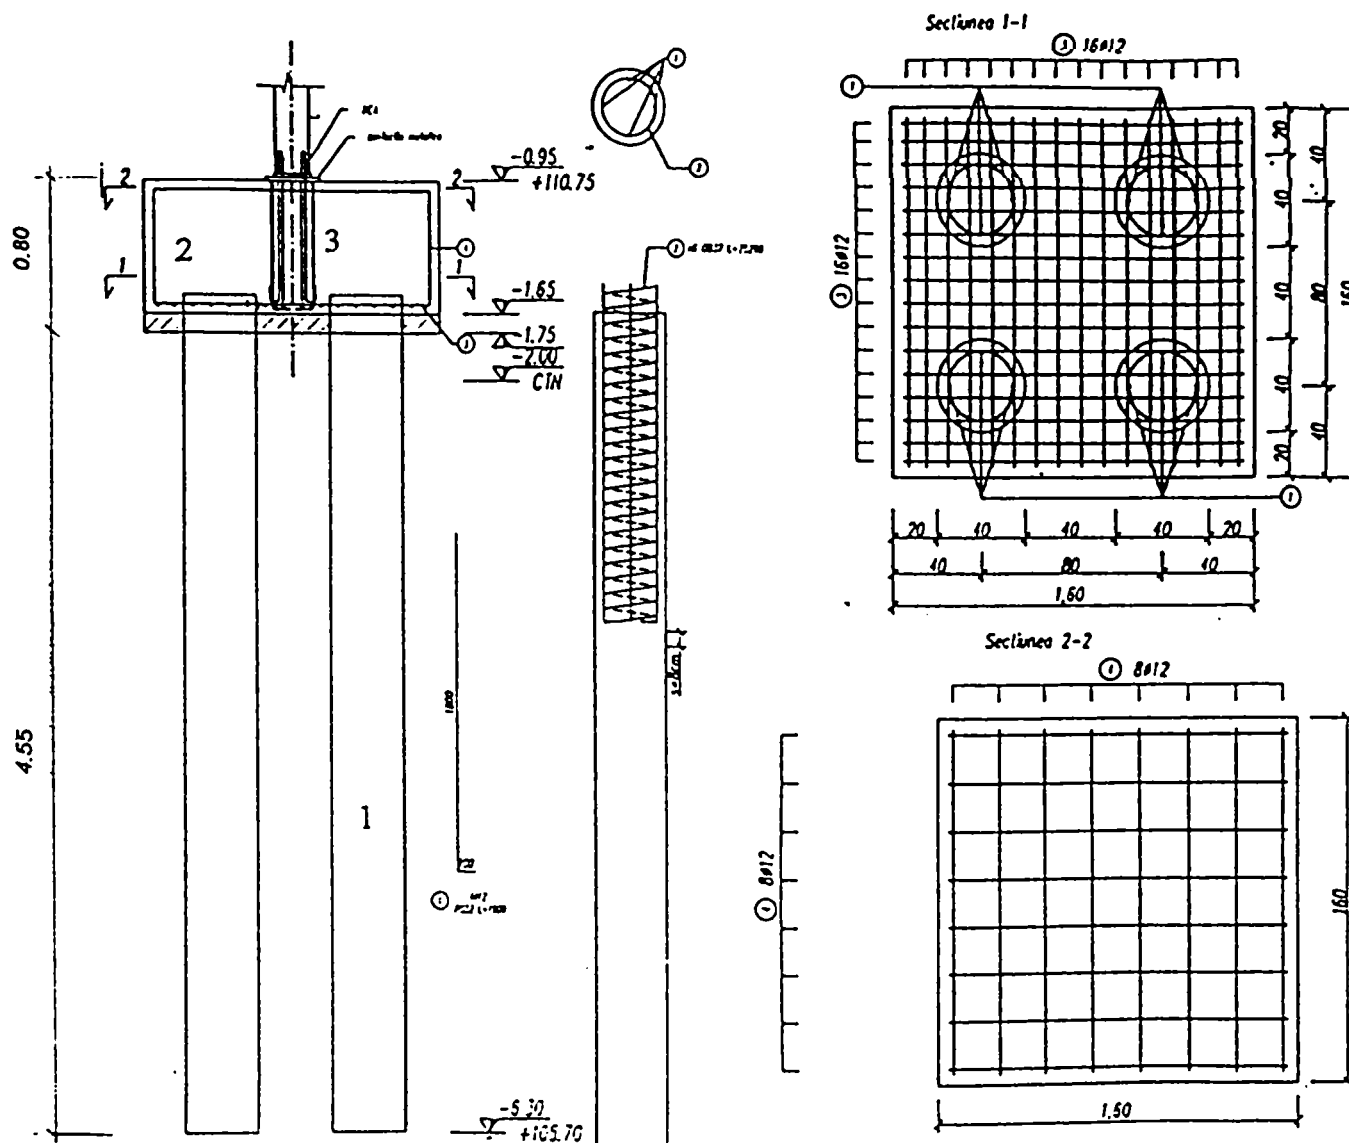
Fundație izolată sub stâlpi. Detalii:
